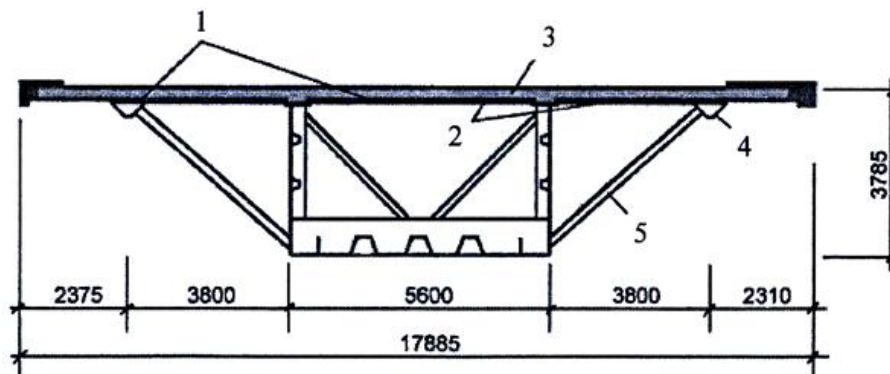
Пролетное сечение железнодорожного моста с корытообразной стальной балкой, объединенной с верхней железобетонной плитой [13]
